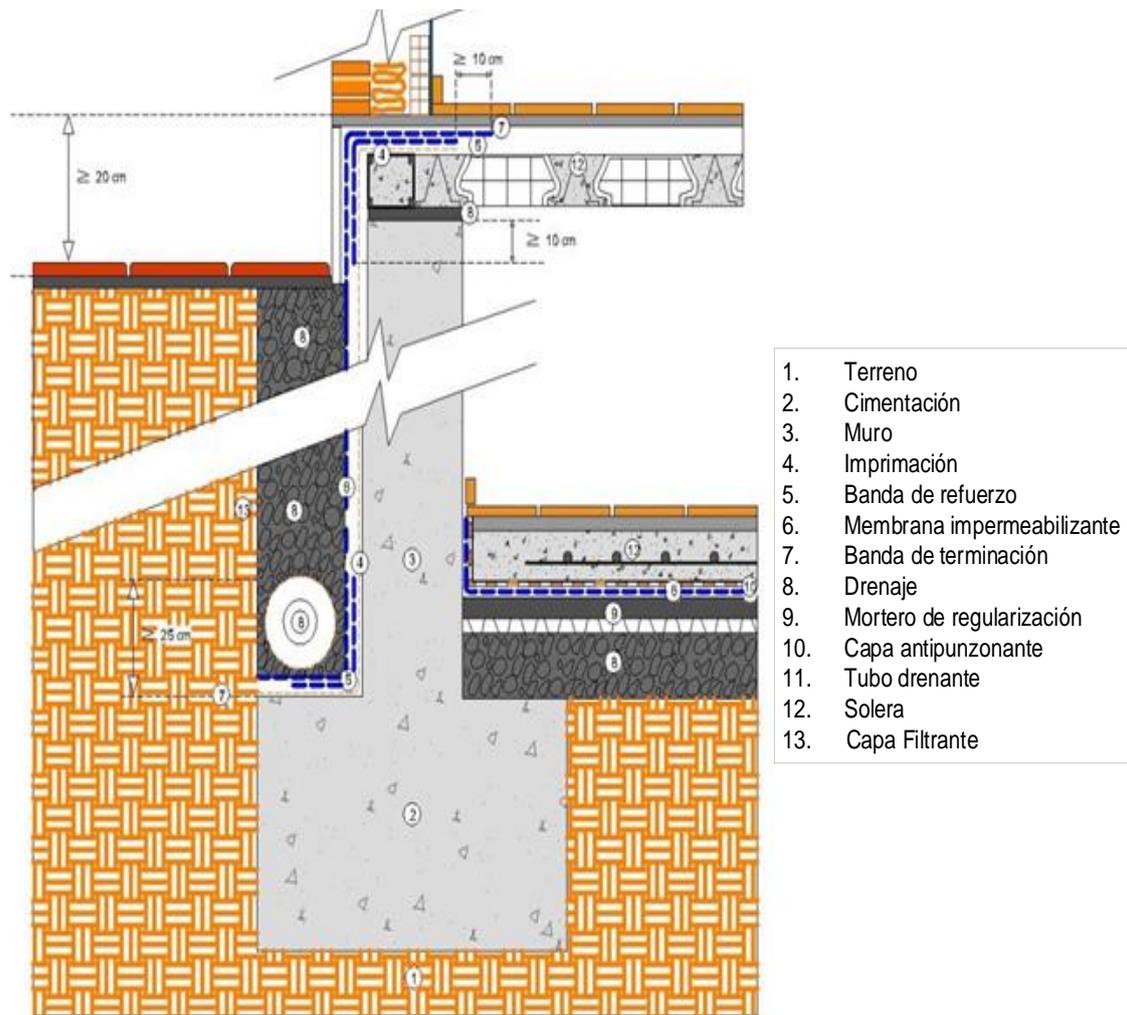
Impermeabilización de cimientos corridos drenaje de lámina nodular
